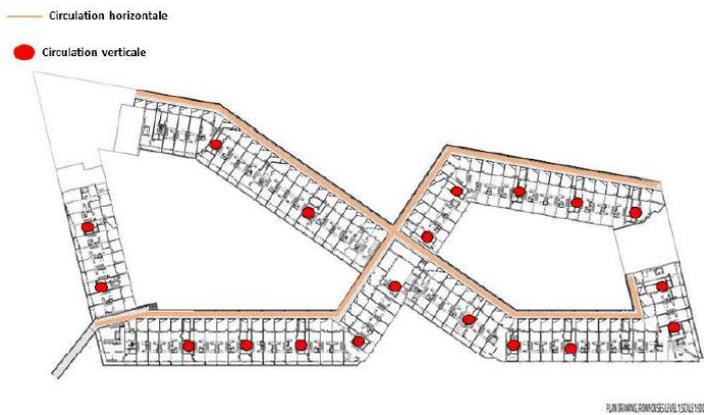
Plan de 1^{er}, 2^{ème} étage / Echelle : 1/500
